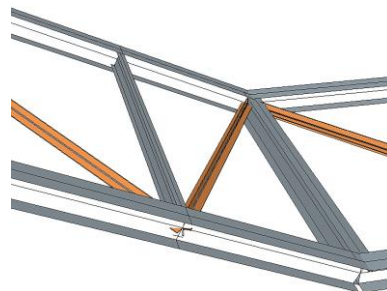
Diagonais e Travessas do Painel Horizontal Superior - Planta
